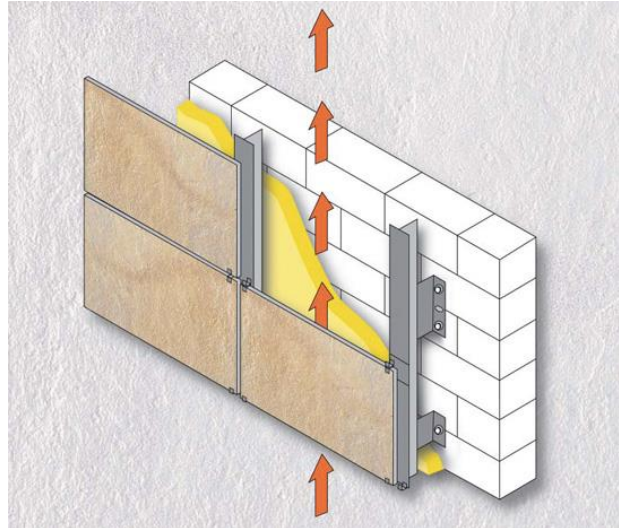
Schéma d'un système ITE de type façade ventilée.
